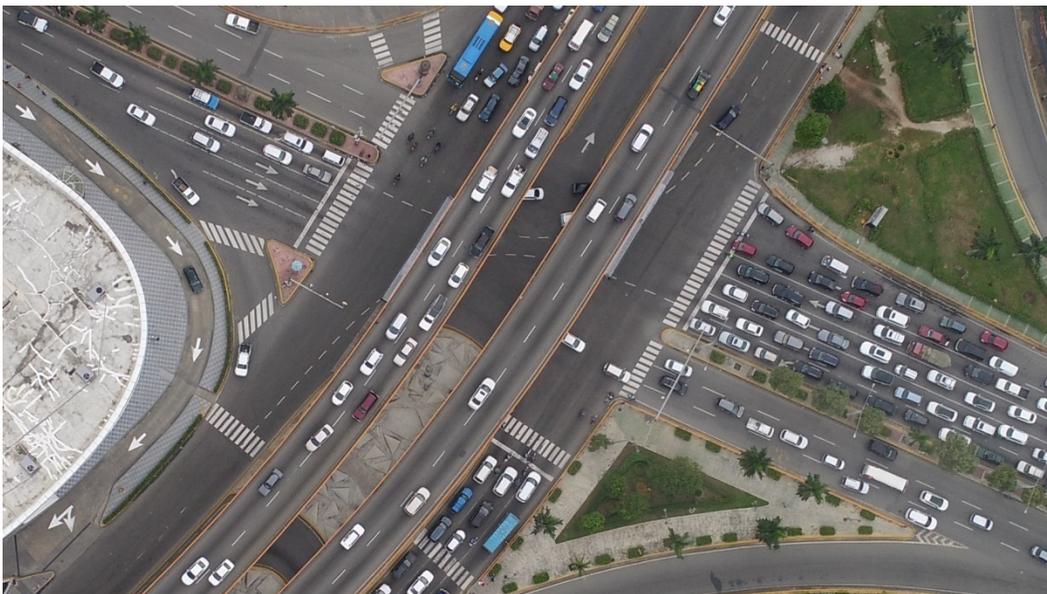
Vista en Planta intersección Av. Abraham Lincoln con Av. John F. Kennedy antes de la intervención.
